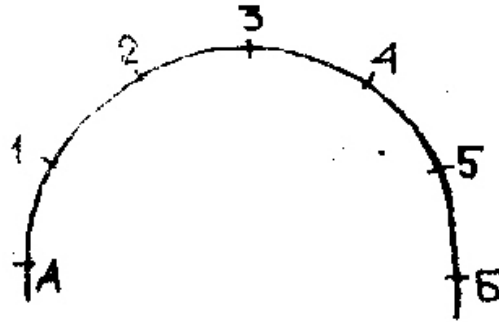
Расстановка размеров на черновой зарисовке обмера арки по способу П.Покрышкина
